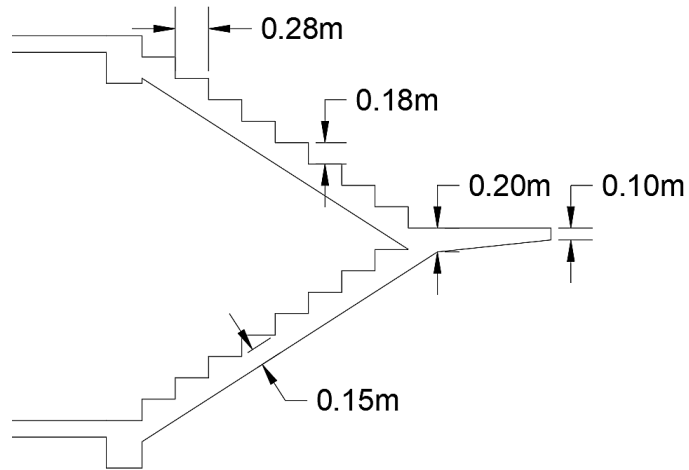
Dimensiones propuestas para escaleras de planta baja y primer piso
